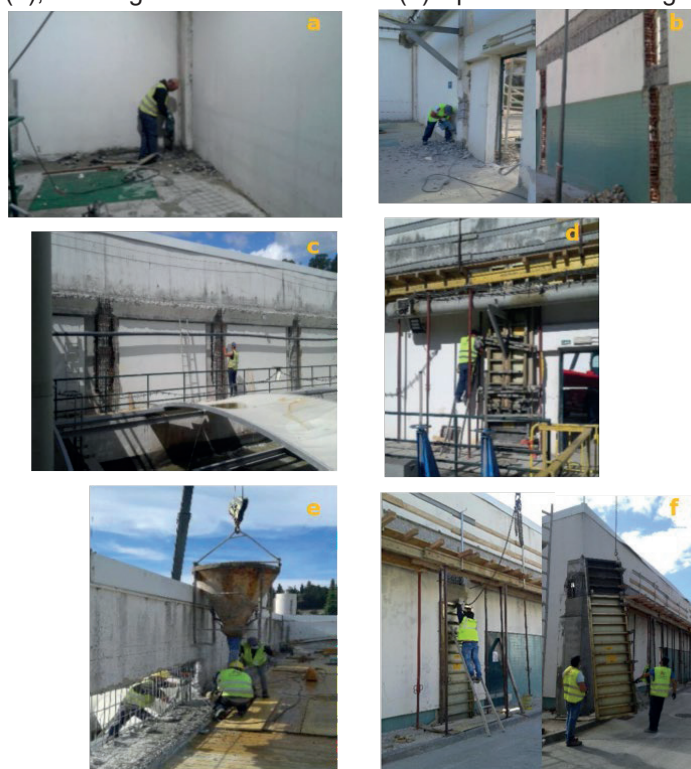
Trabalhos de reforço das fundações, pilares e vigas no edifício dos desarenadores e decantadores primários
